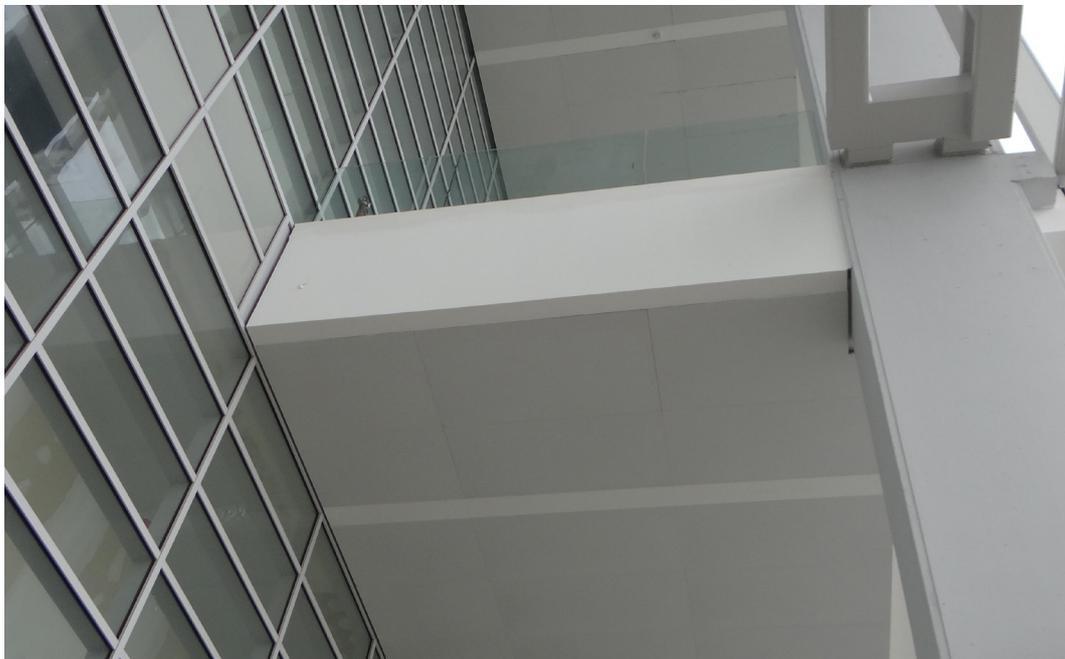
Foto pianerottolo giardino d'inverno piano 42
